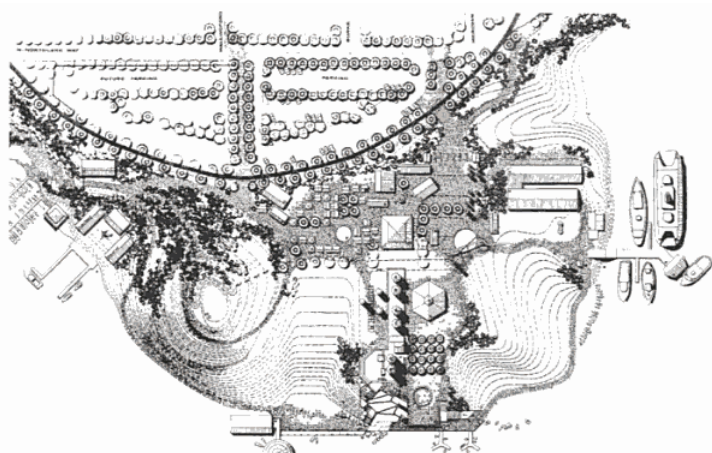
Plano Geral do Gas Works Park (SAUNDERS, 1998)
